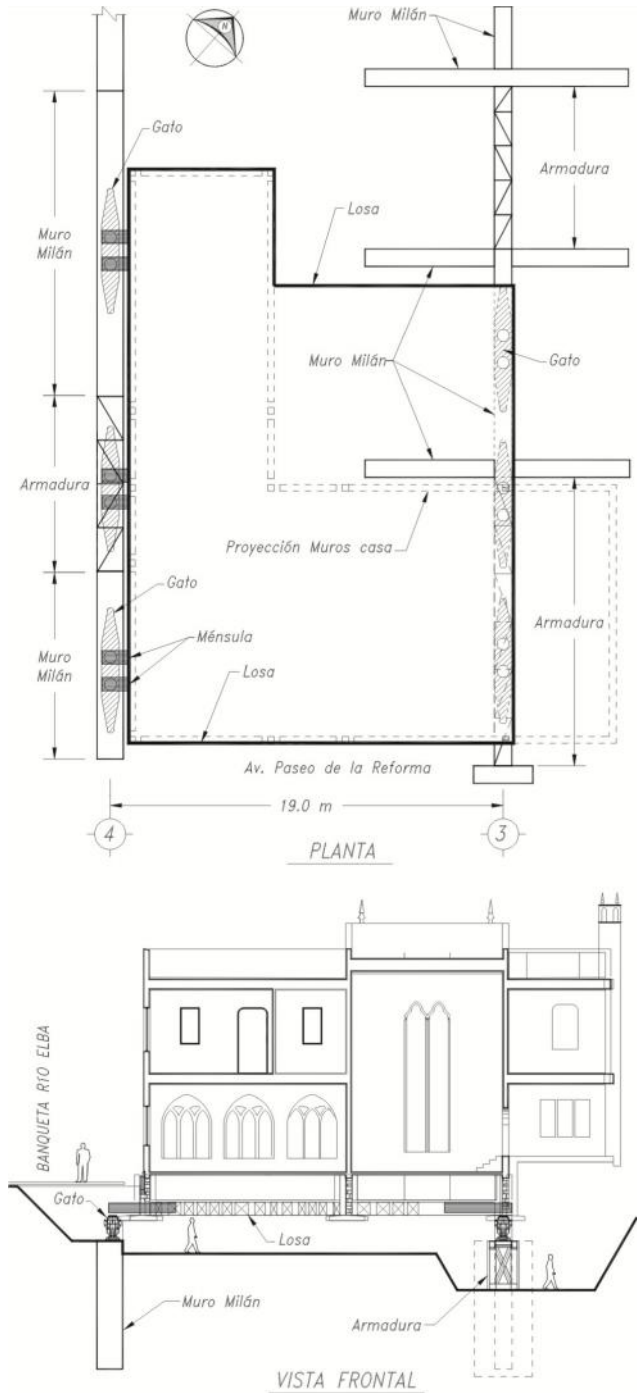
Esquema con la ubicación en planta de la cimentación de apoyo para los rieles durante el movimiento
